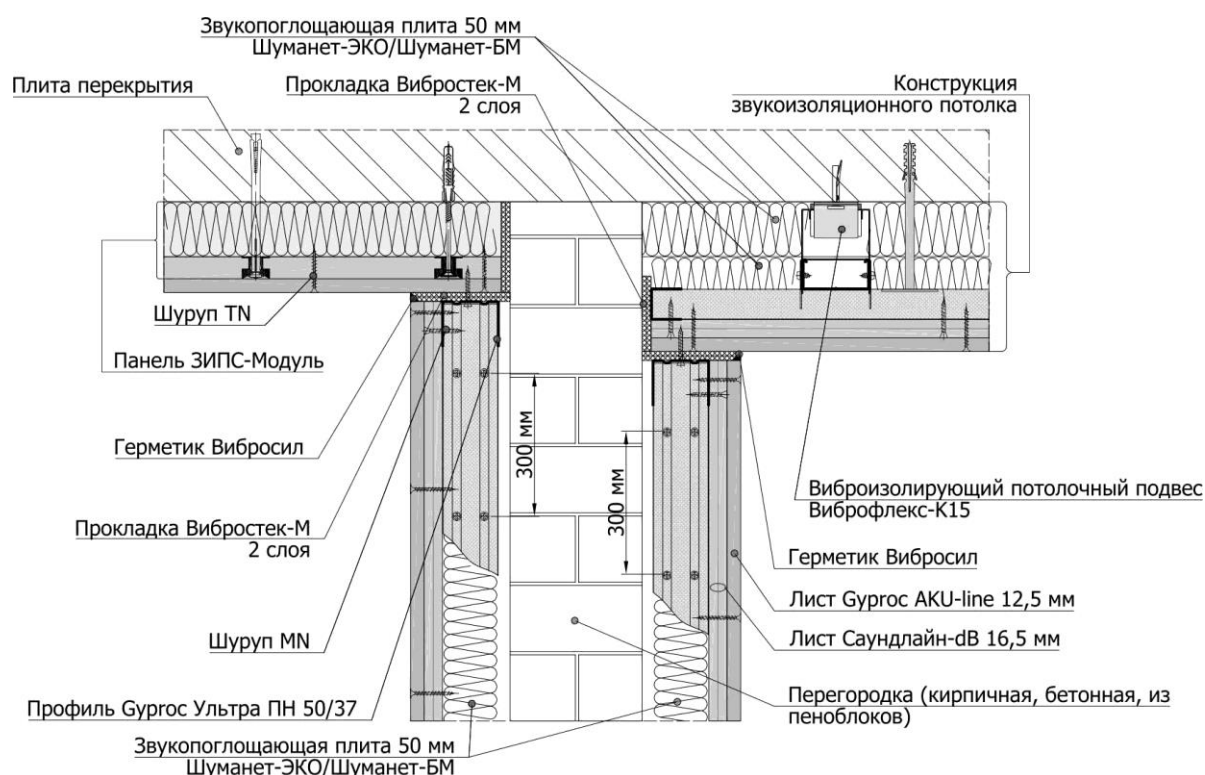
Примыкание облицовки стены на независимом сдвоенном каркасе 50 мм к панелям ЗИПС на потолочном перекрытии и подвесному звукоизоляционному потолку
